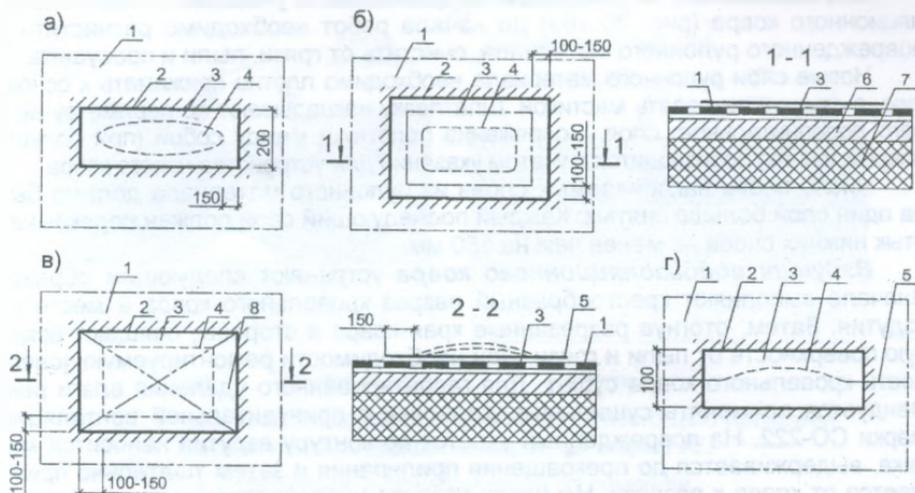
Устройство заплат на рулонных кровлях в местах:
